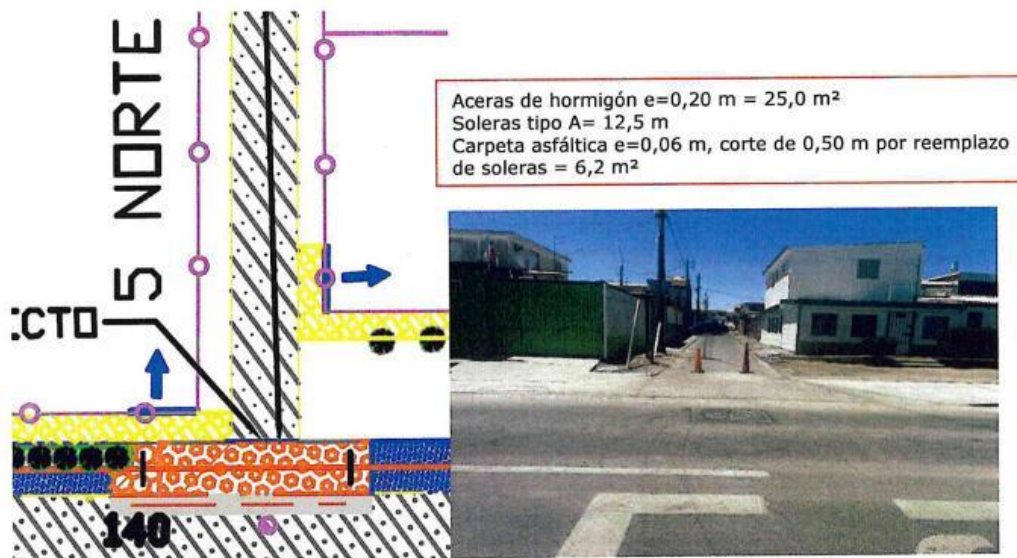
Disminución de aceras de hormigón de e=0,20 m en buen estado en encuentro calle Nueva Oriente con pasaje 5 Norte.
